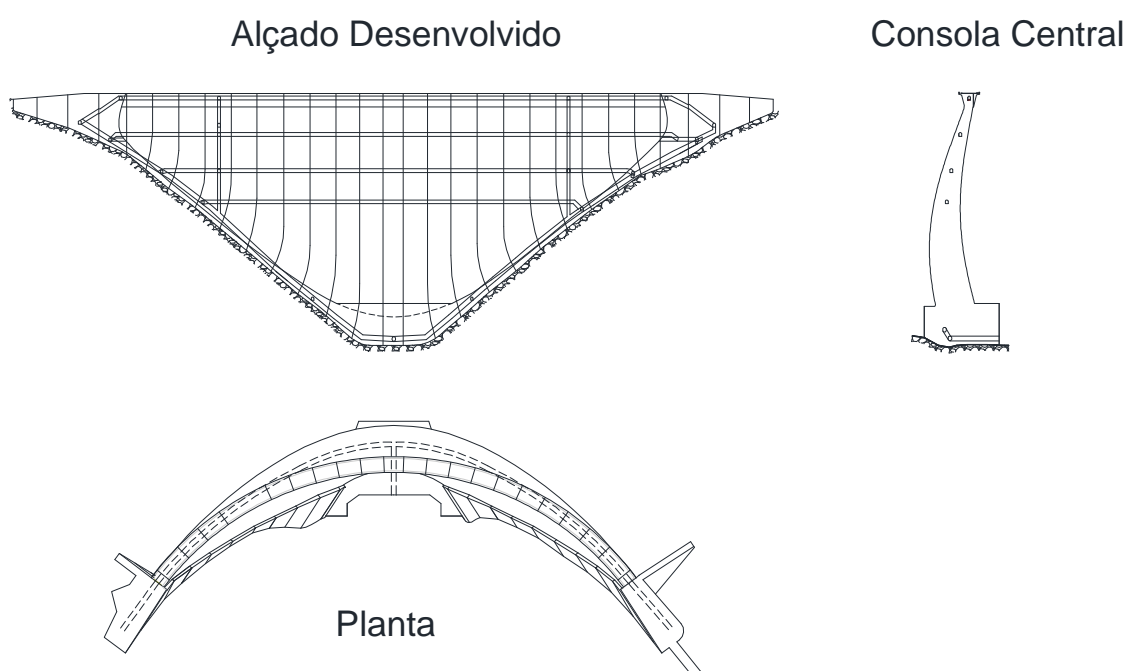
Barragem do Cabril. Alçado desenvolvido, consola central e planta.
